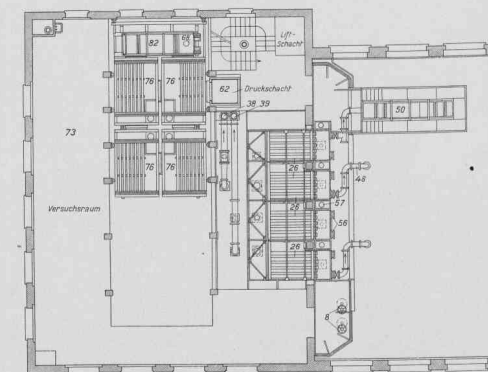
Grundriss des ersten Stocks des Nordflügels.
